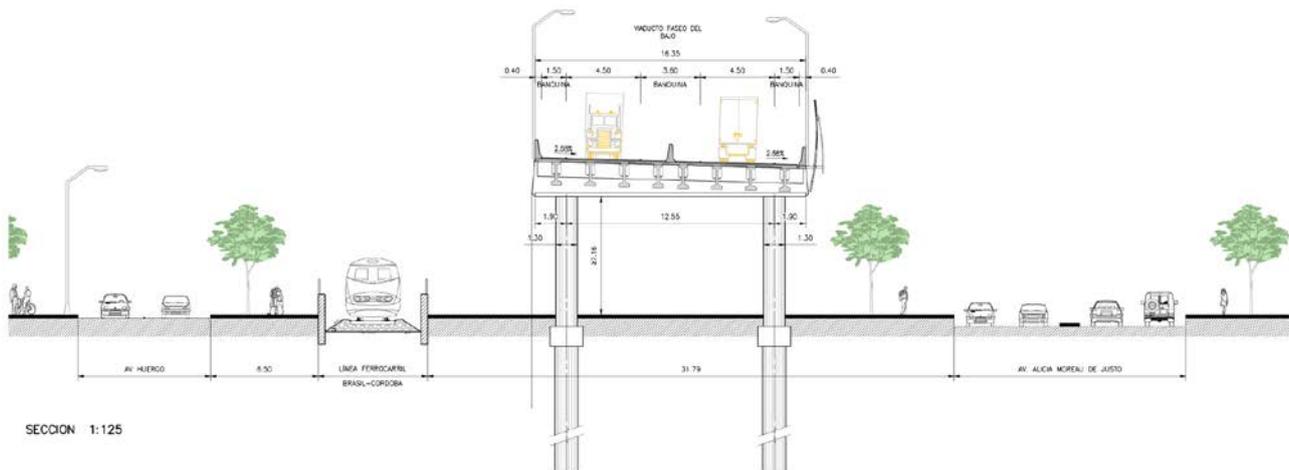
Sección Tipo Sur Principal. Doble Calzada
